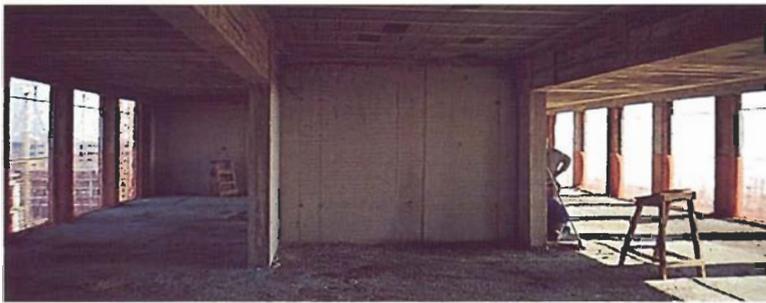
La estructura de una vivienda muestra la disposición de los elementos verticales, cajas de escalera núcleos de medianería y dos series de pilares en el plano de las fachadas. Los pilares interiores se evitan con las dos grandes jácenas para liberar distribuciones posteriores de la planta.
